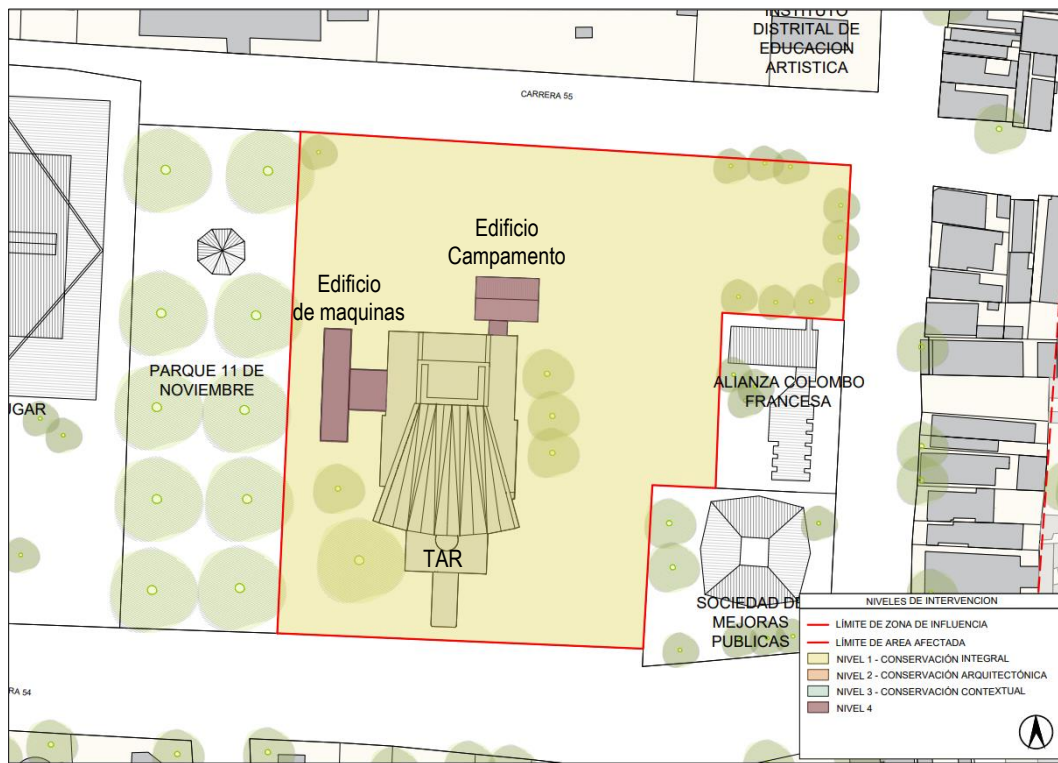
Plano F3 Plano de propuesta de niveles de intervención en el área afectada Fuente: Consorcio NVP
